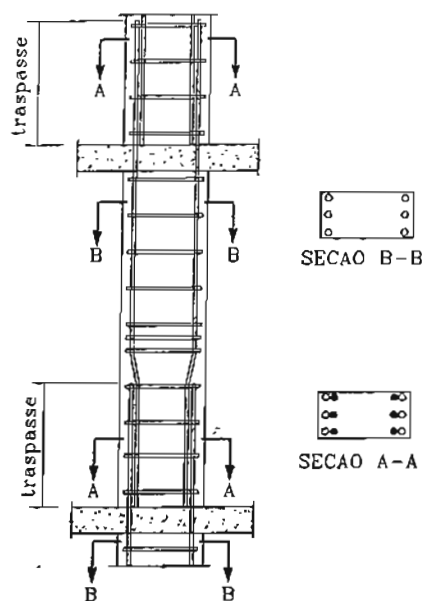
Emendas de armadura para pilares de seção constante, em lajes sem vigas
